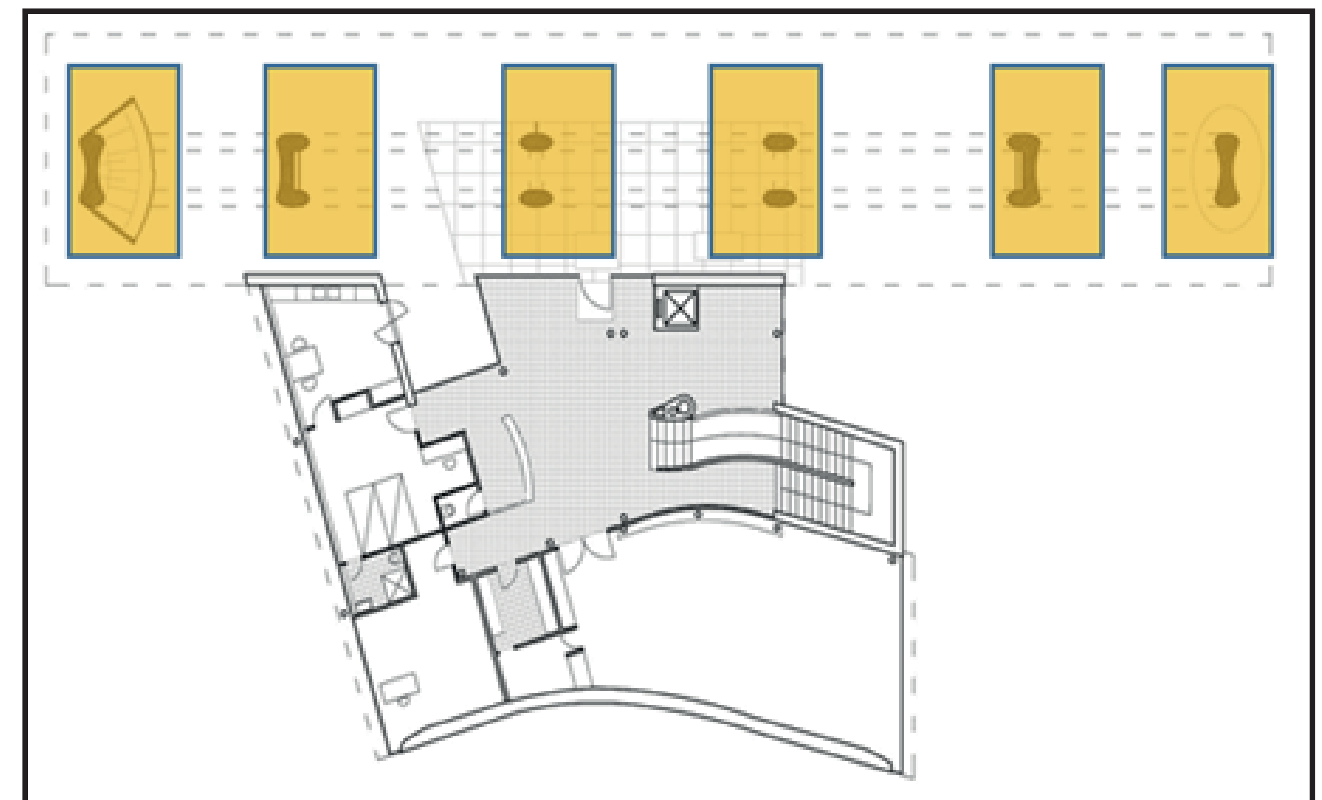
Fuente: Wikipedia. Planta estructural, Pabellón suizo.
